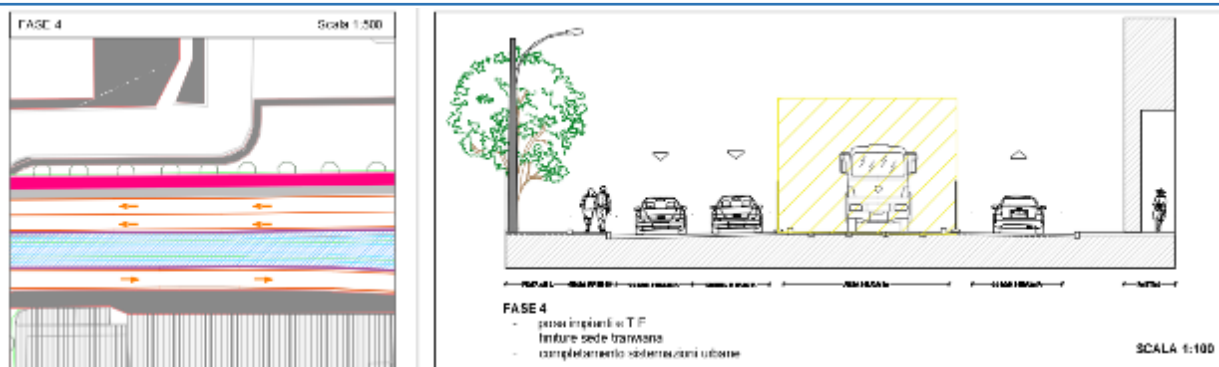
Tipologico cantiere con sede centrale Fase 4
